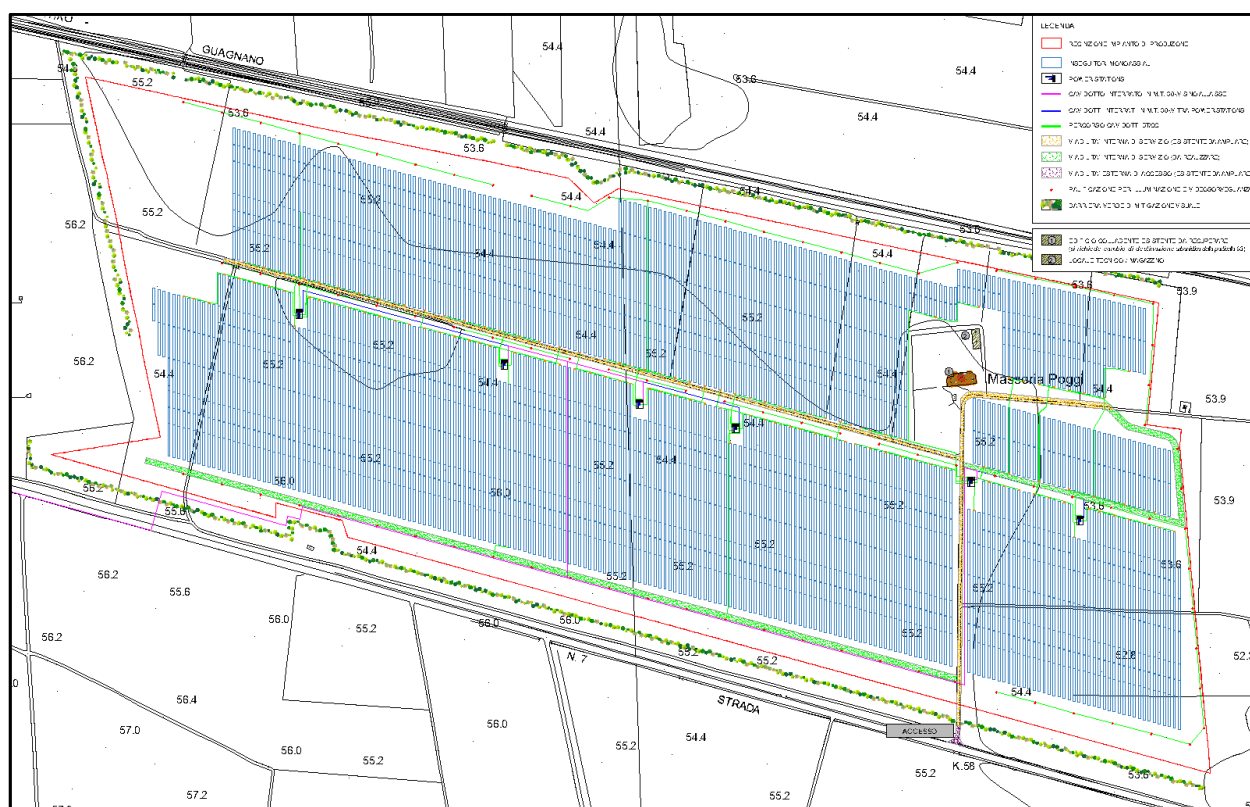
Layout impianto di produzione con indicazioni del sistema di viabilità interna
